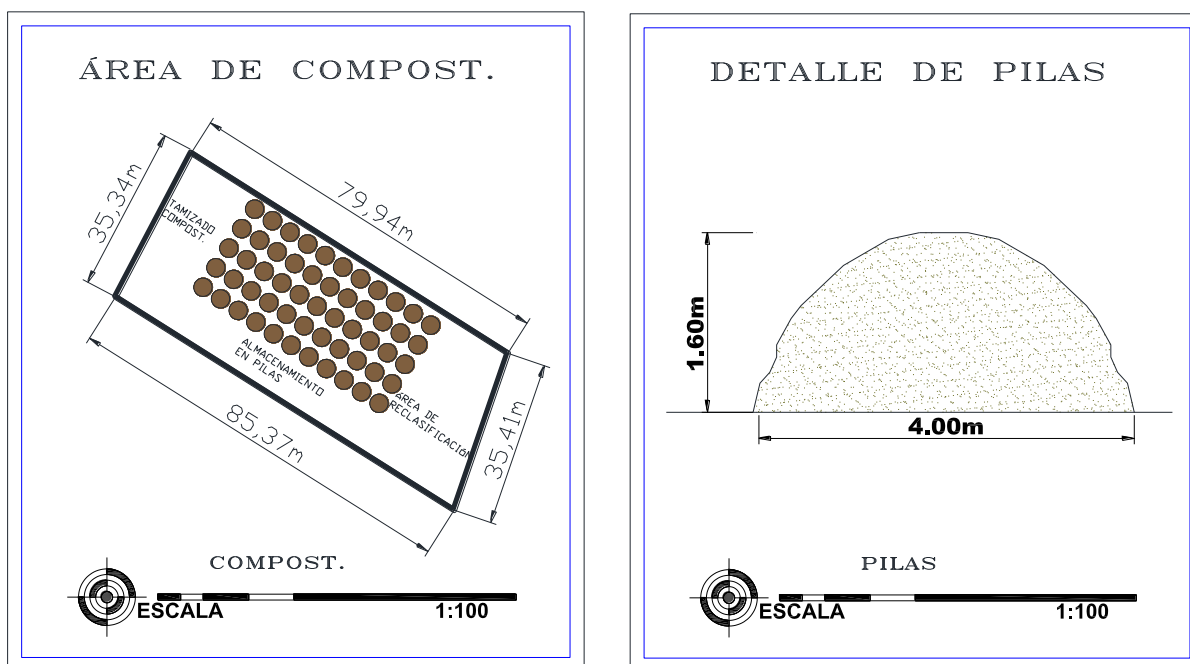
Esquema planta de compostaje. Elaborado por: El Autor
